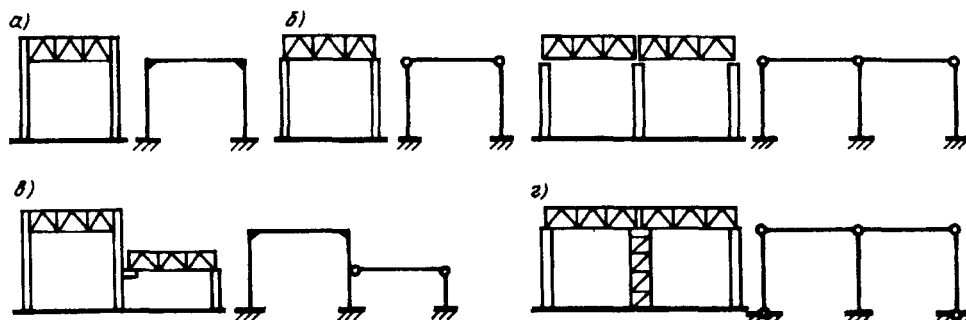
Виды сопряжения ригеля с колонной и расчетные схемы поперечных рам
